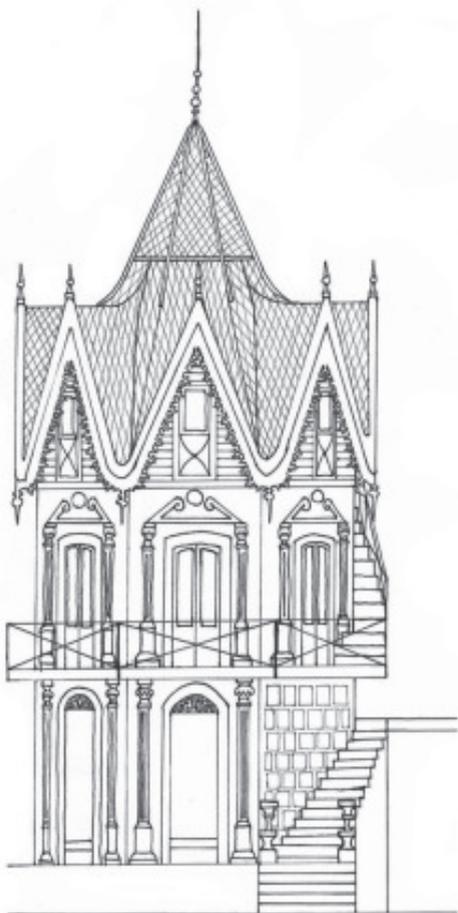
Teijeiro Mosquera: Alzado do Pavillón. AAPP.
